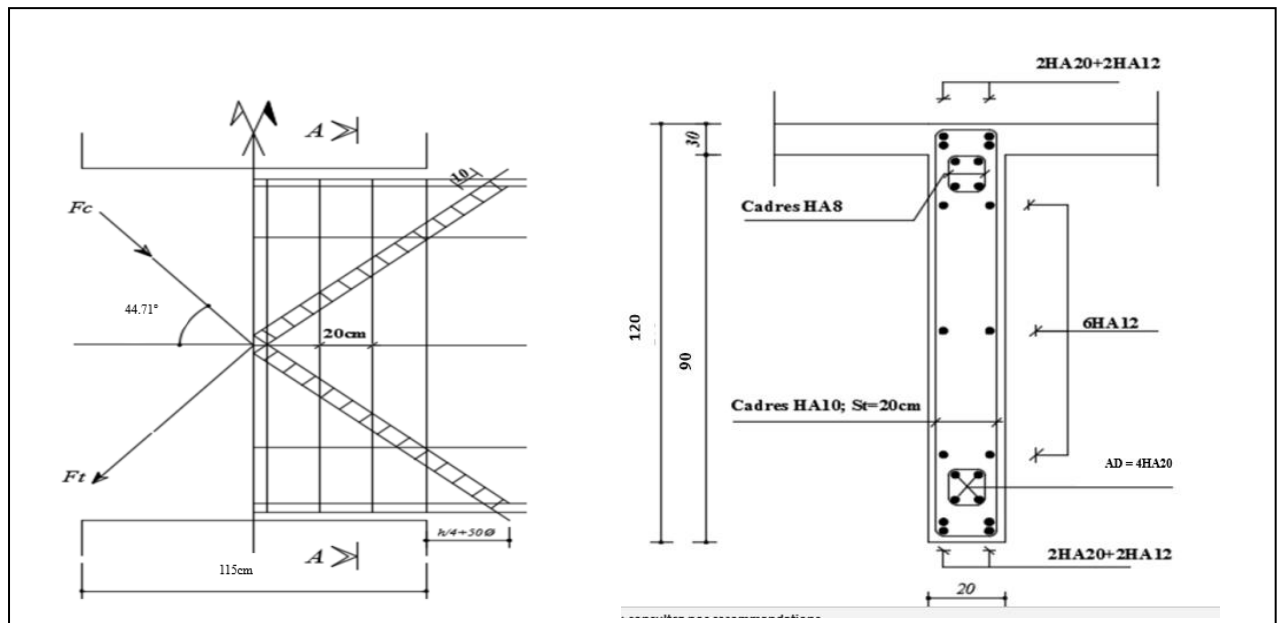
Schéma ferrailage de linteau (VL1/BC)RDC
